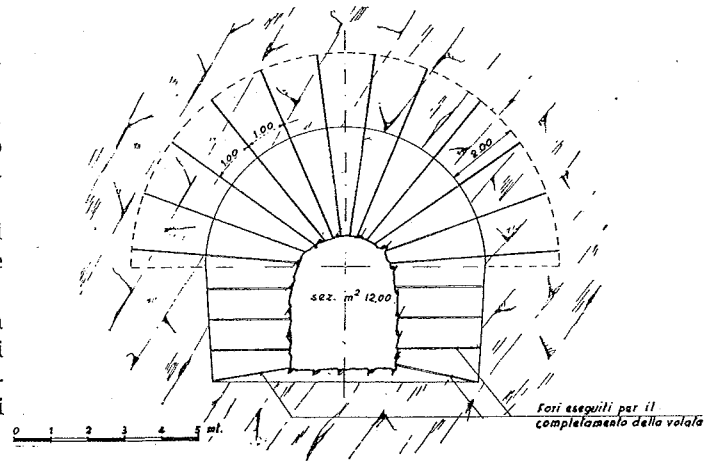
Sezione trasversale galleria St. Pierre-Cagnet.
